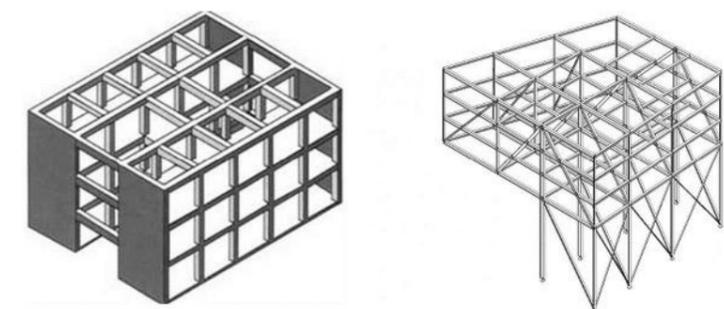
Sistema estructural aporticado, muros portantes y cerchas.
